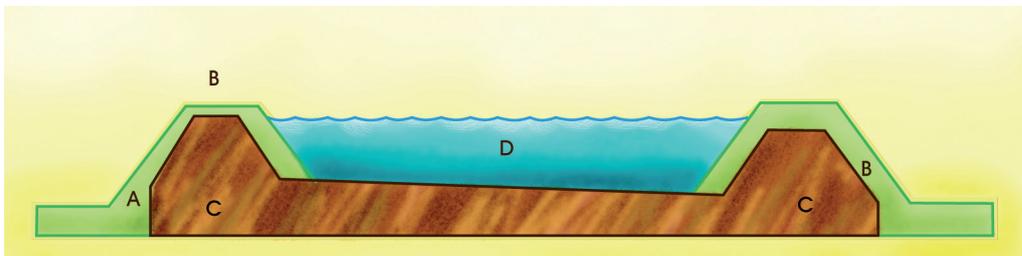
Corte sagital de un estanque de producción. A: borde para instalación de sistema de llenado, B: borde para instalación de sistema de drenaje, C: corazón de arcilla para incrementar la impermeabilidad del estanque, D: pendiente en el fondo para hacer más eficiente el drenaje parcial o total del estanque, E: terraplenes para el mantenimiento del estanque o manejo del cultivo.
